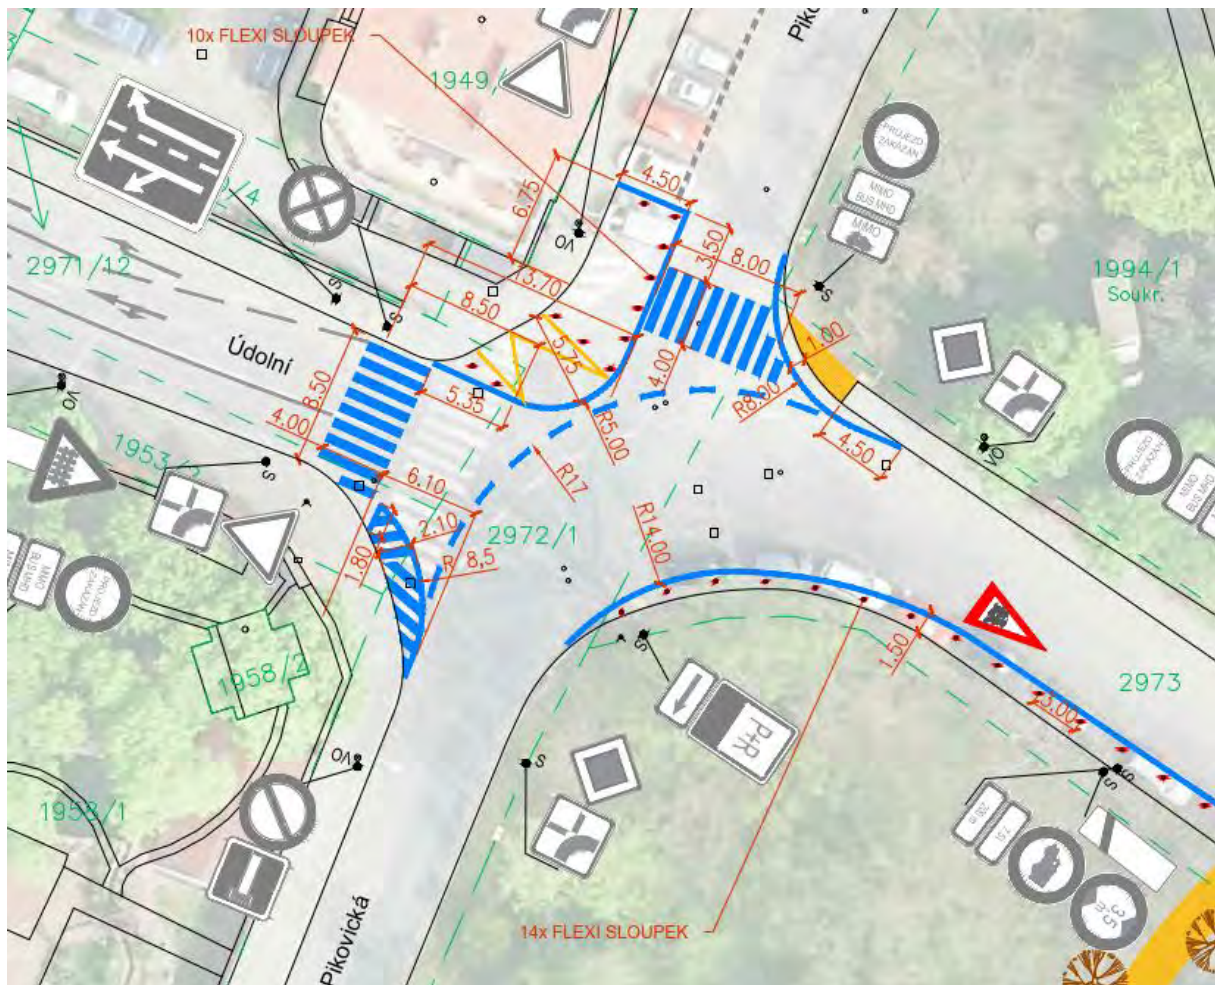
Detail nestavebního řešení na vjezdu do areálu branického pivovaru
